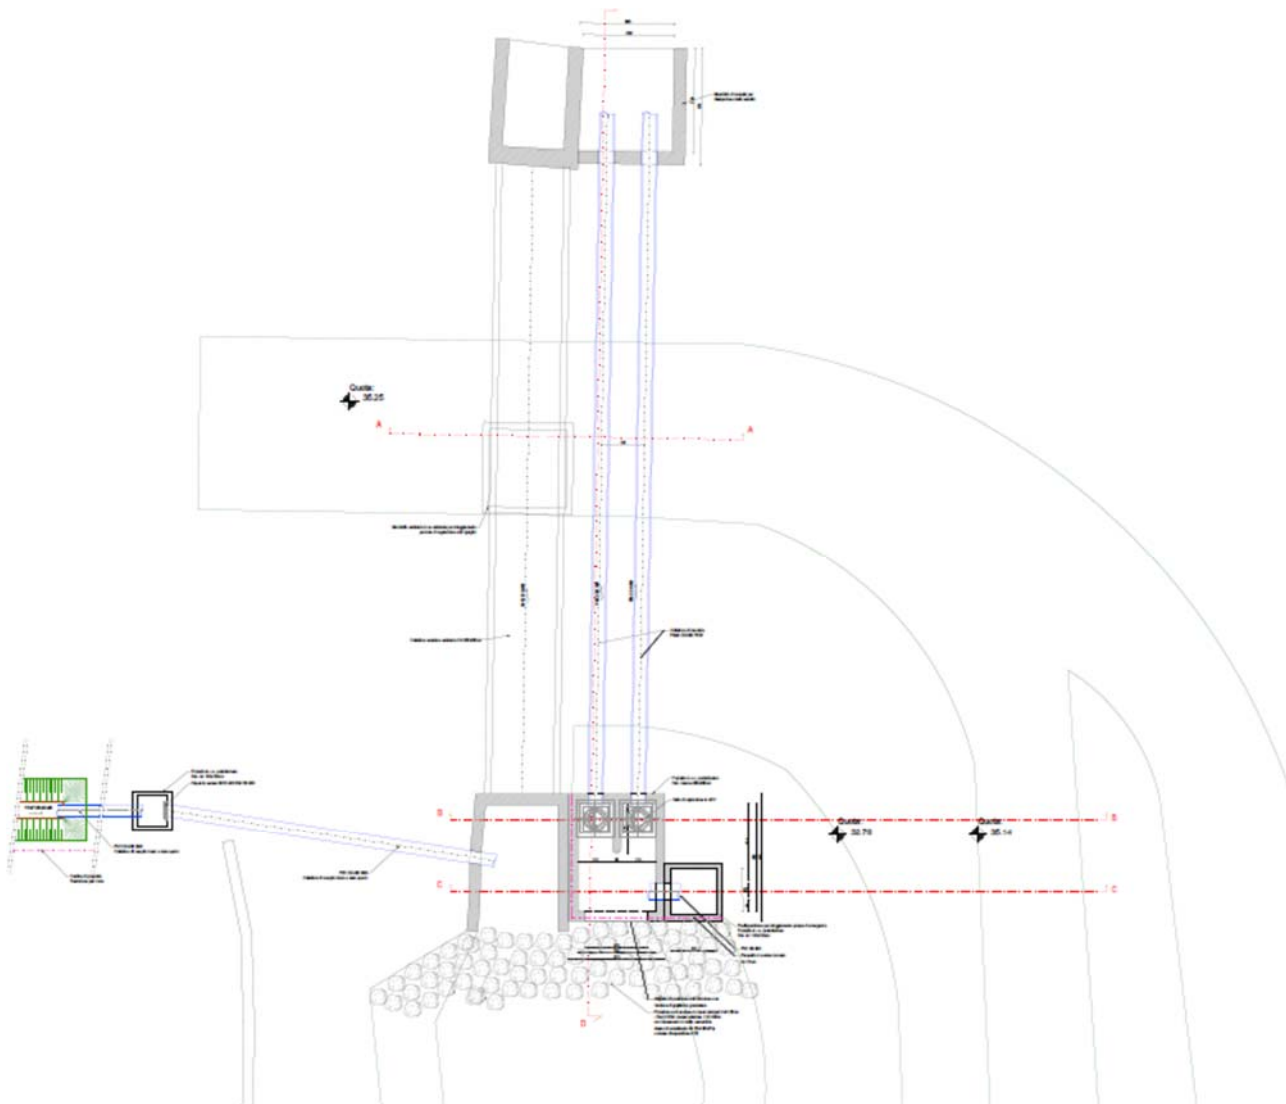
Dettaglio planimetrico area impianto di sollevamento.
